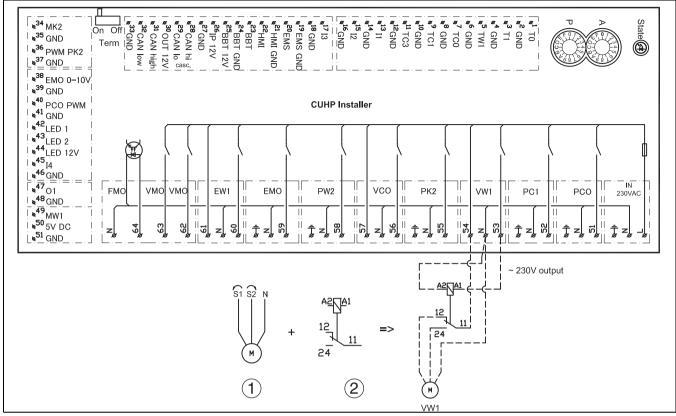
Installazione alternativa valvola di commutazione a 3 vie
